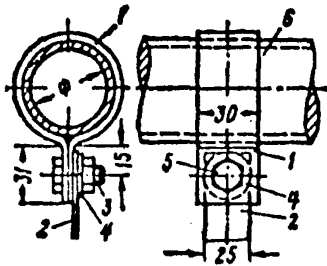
Присоединение заземляющего отвода к трубопроводу с помощью хомута:
